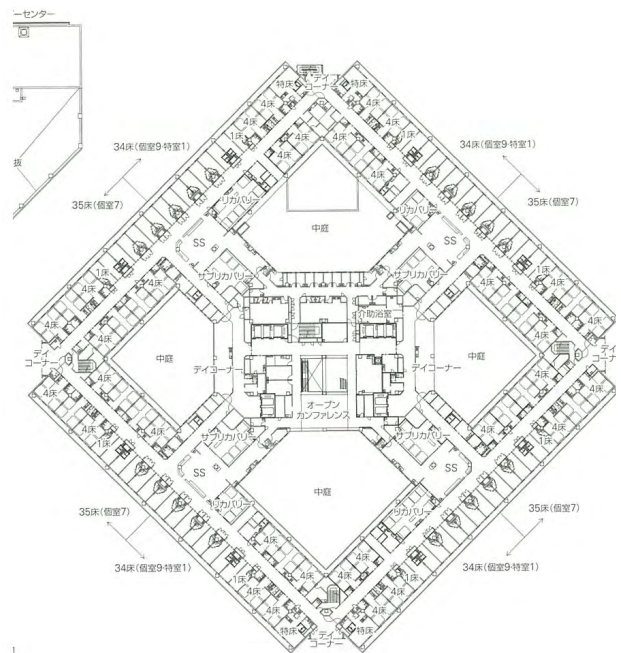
一階平面図および病棟平面図 (月刊近代建築 2012 年 11 月号より引用)
